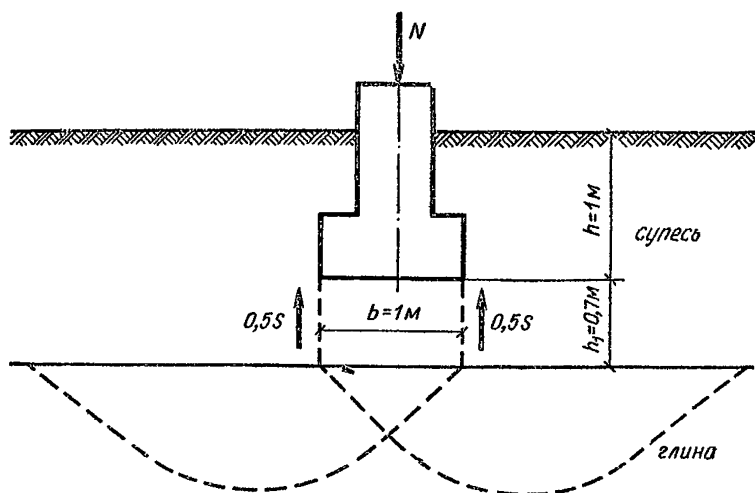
Схема фундамента и двухслойного основания к примеру расчета несущей способности
